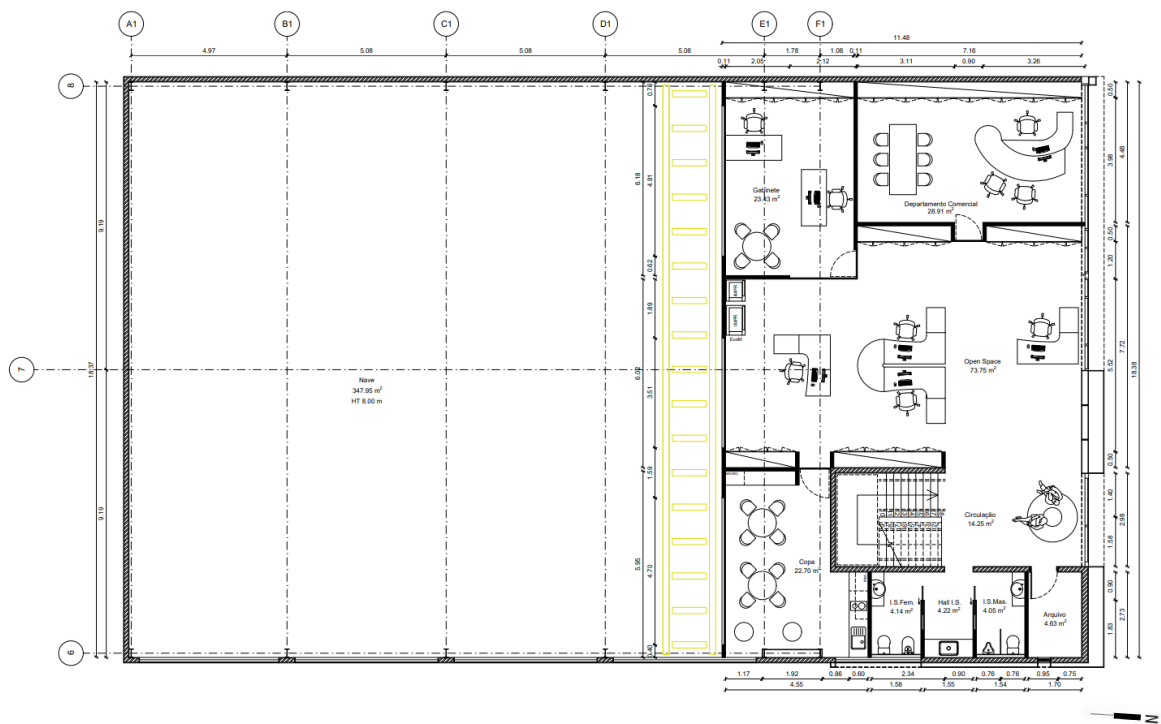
Proposto - Plantas do piso 1 (EP_R03). Fonte: Garq / Desenvolvimento: Autora.
